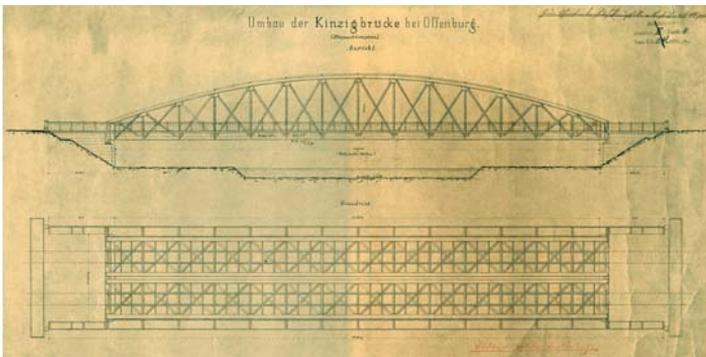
Umbau der Kinzigbrücke bei Offenburg, Planzeichnung, 1883_ GLAK_421-K2-664
